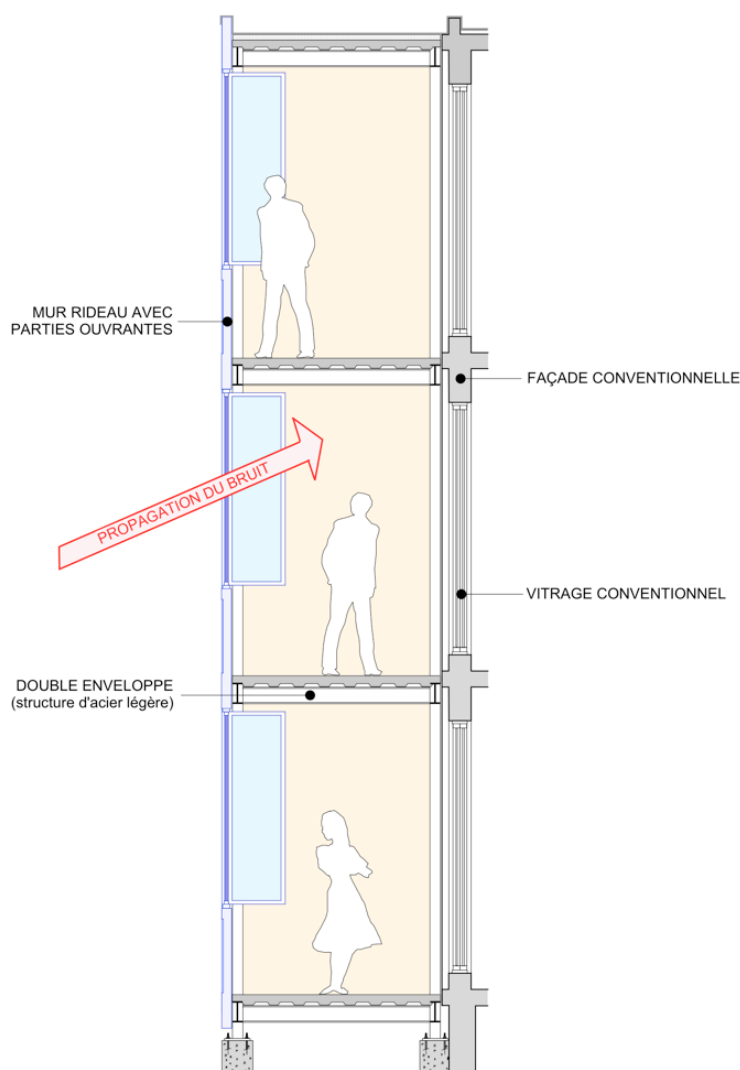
b : Ajout, sur la façade d'un édifice existant, d'une double enveloppe accessible et fenêtrée
